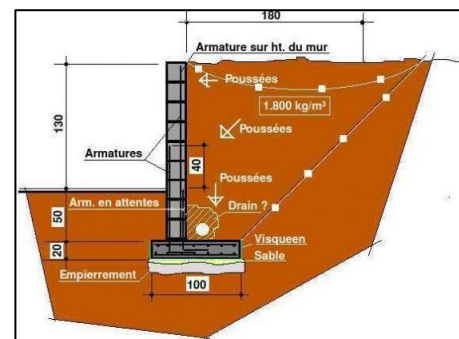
Détail mur de soutènement [Source : www.bricozone.be].
